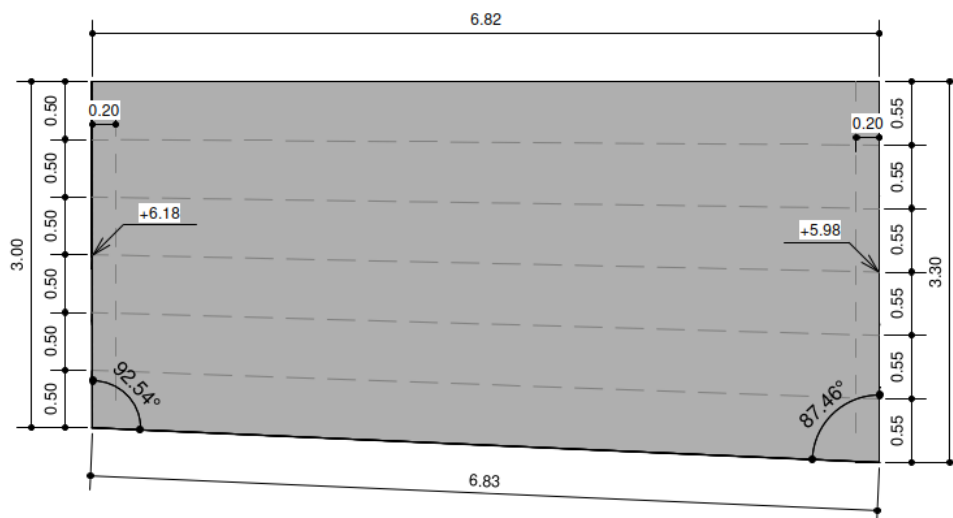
Vue en plan du platelage de type 7 (platelage d'extrémité rive droite)
